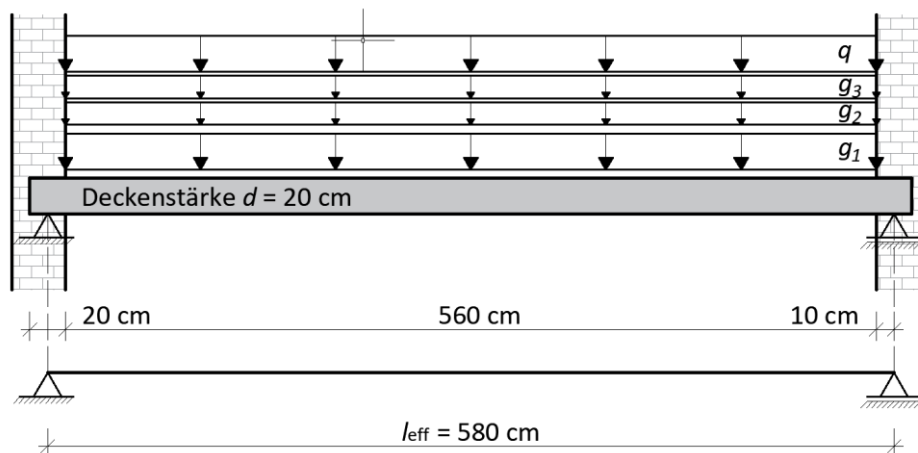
Oben: Längsschnitt durch die Decke mit einwirkenden Lasten, unten: statisches System der Decke in Längsrichtung
